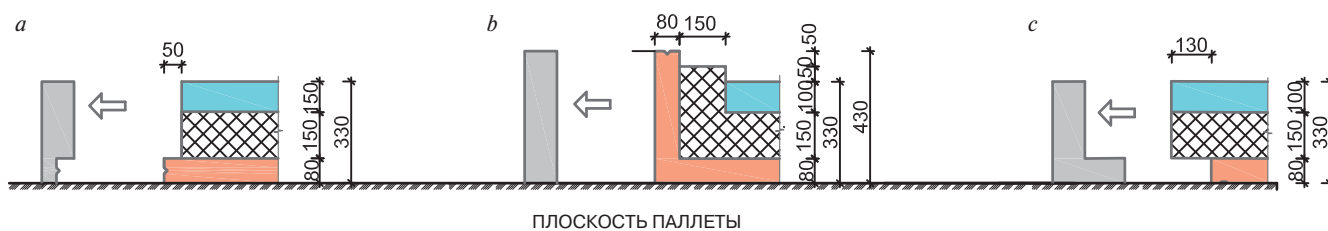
Профили вертикальных поперечных бортов для формирования ступенчатых фасадов: а – для рядовой и торцевой панелей наружных стен; б – для торцевой и накладной панелей наружных стен; с – для поперечного борта накладной наружной панели
